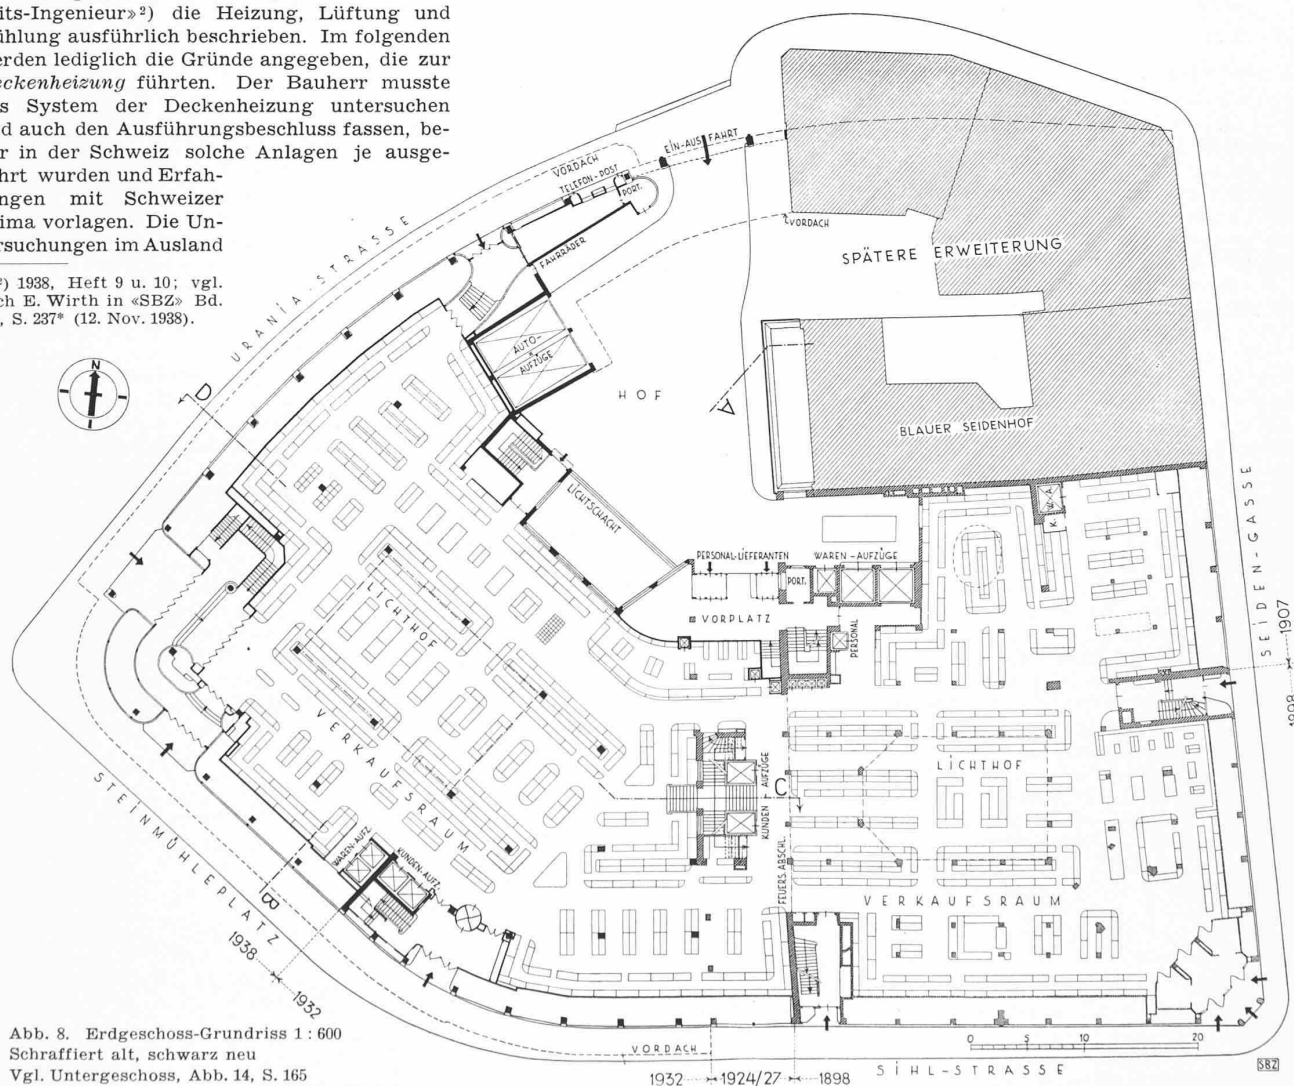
Erdgeschoss-Grundriss 1:600
